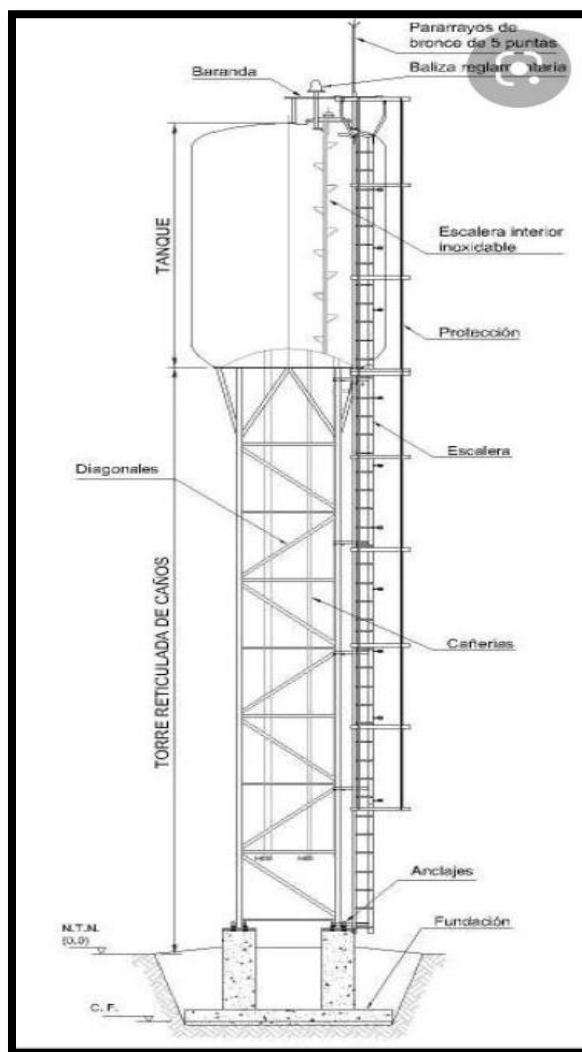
Detalle de otro sistema de construcción de torre.
